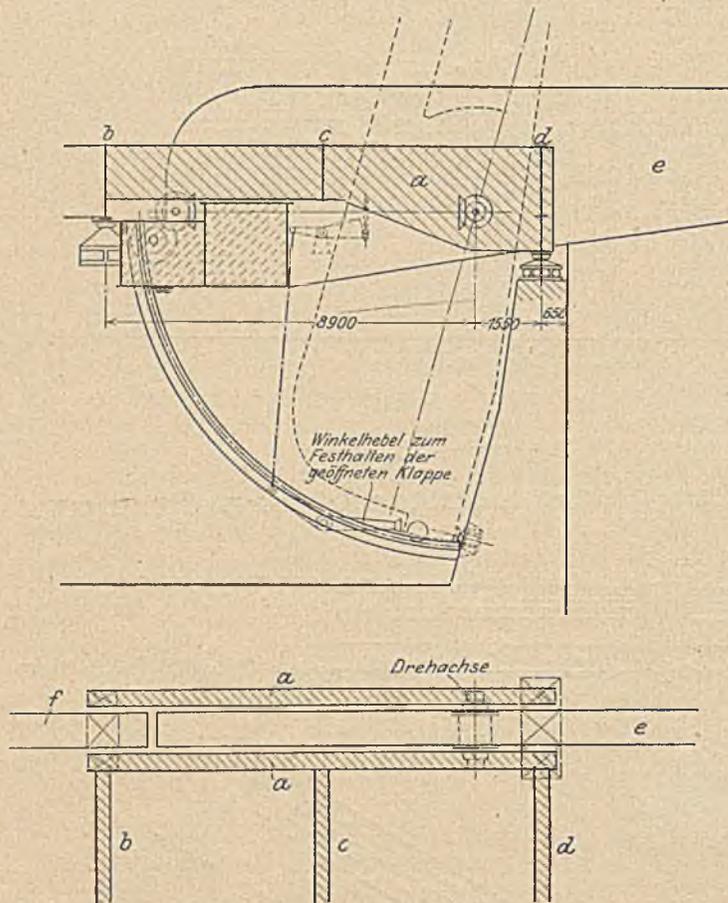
Klappbrücke, Längsschnitt und Grundriß.
